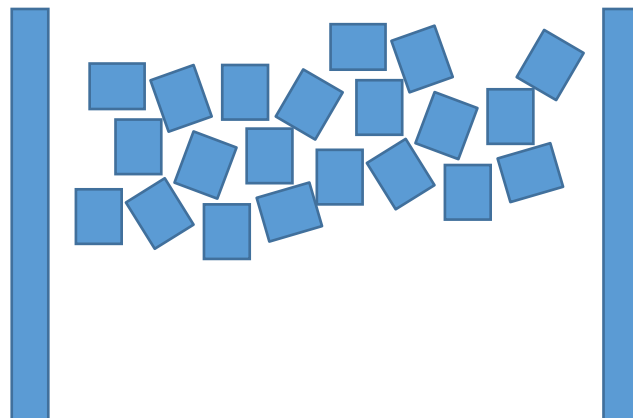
Vista esquemática em planta do assentamento tipo malhete.
